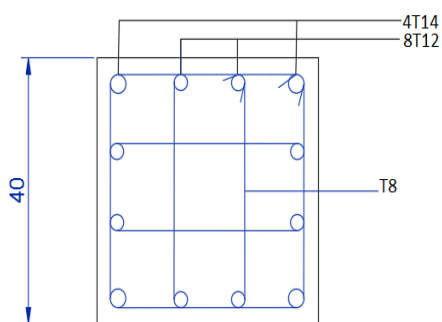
Schéma de ferrailage des poteaux(40;40)
